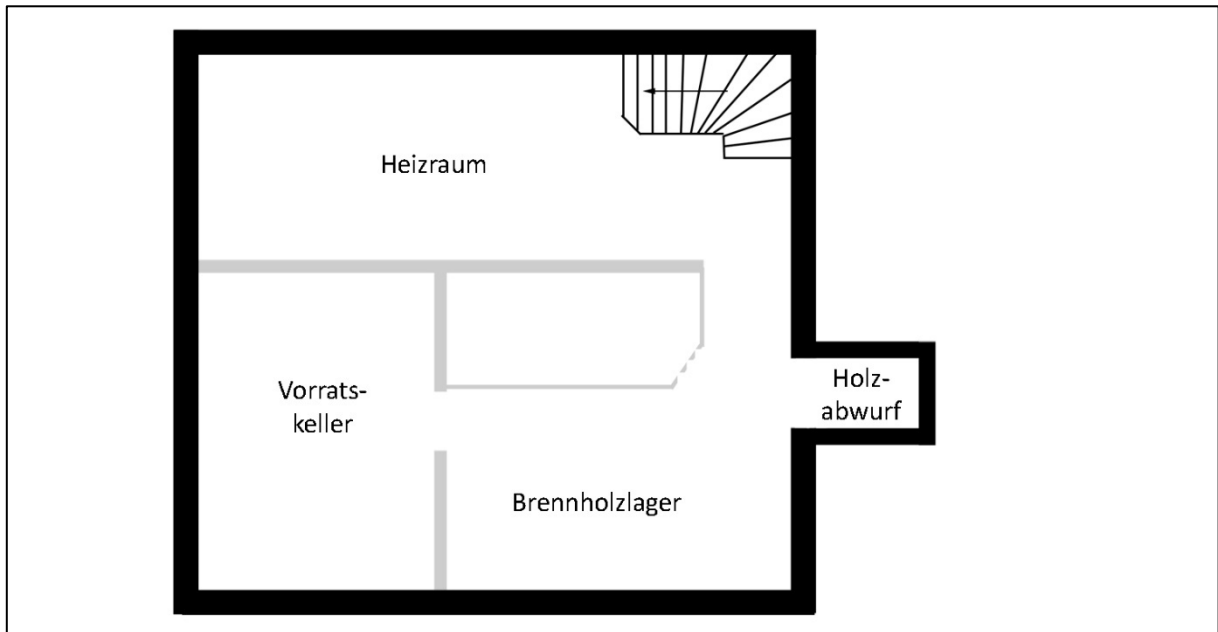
schematischer Grundriss des Kellergeschoßes
